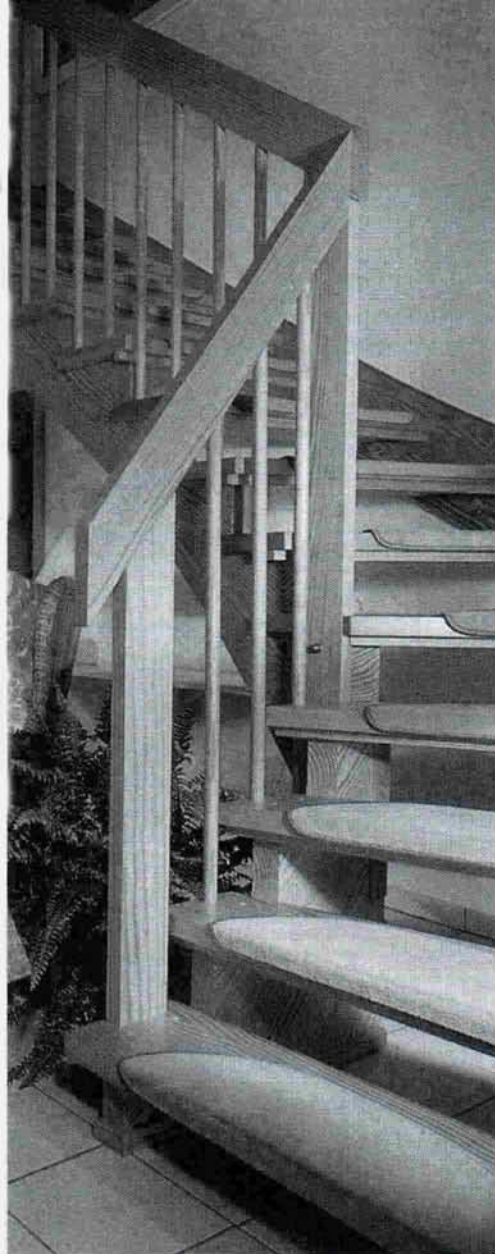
Лестница, ведущая на второй этаж из жилого фойе, смежного с жилой комнатой.
